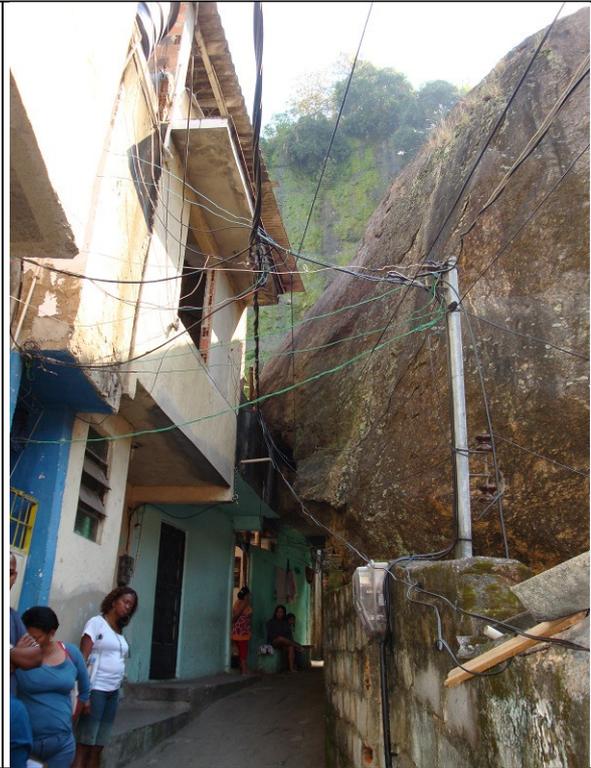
Casas situadas no pé da encosta/bloco de rocha proveniente de desmoronamento ocorrido em 1968
